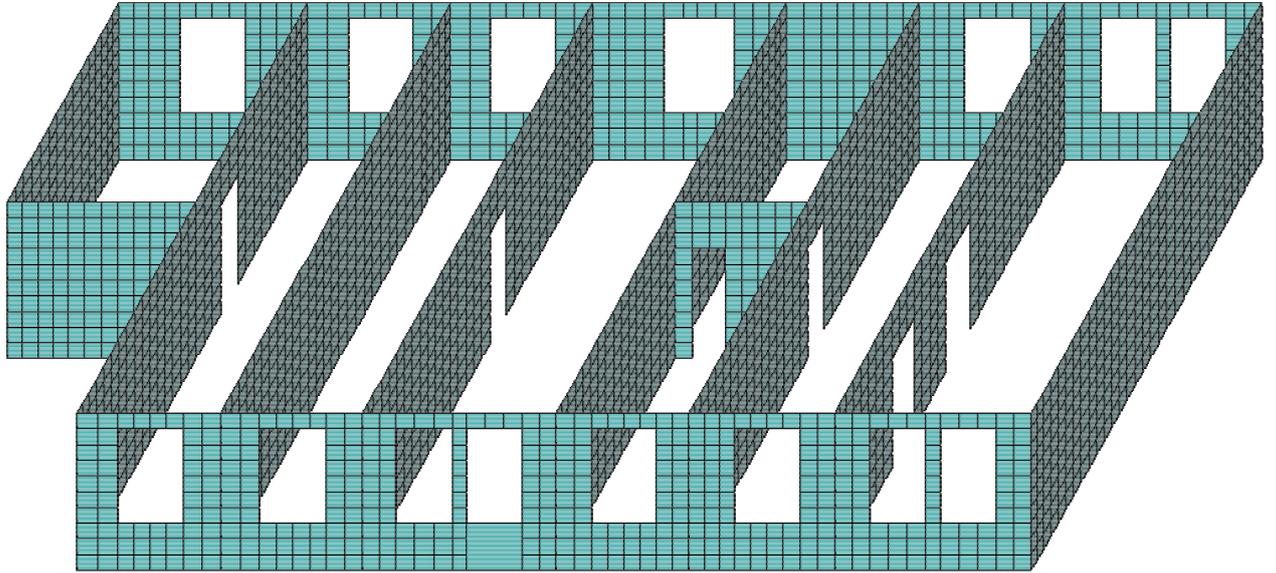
Розрахункова схема несучих стін нежитлових приміщень 1-го поверху до реконструкції.
